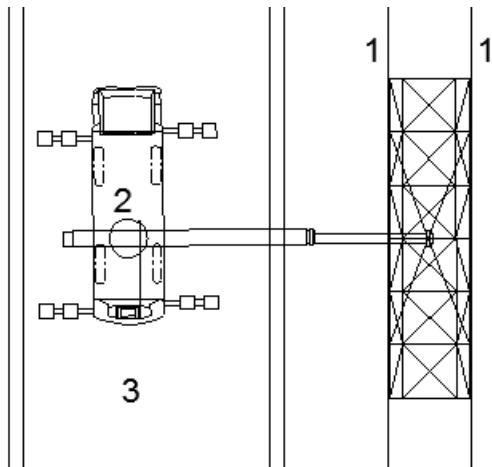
Posicionamiento de la sección de cercha entre los cables principales. (Elaboración propia).
